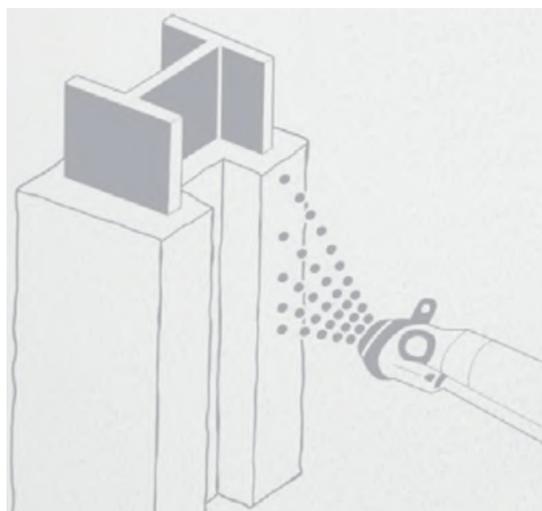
Ilustración de una aplicación de yeso sobre un elemento estructural.
